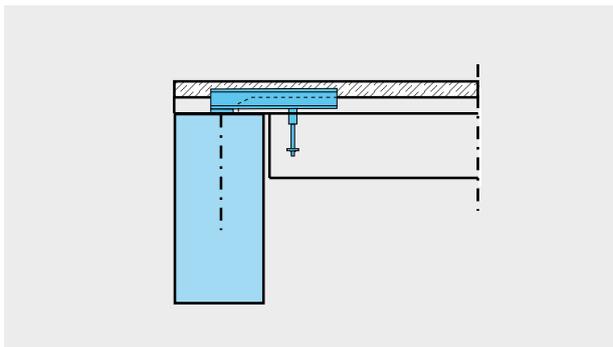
Stahlaufleger mit zentraler Auflagerung auf Randunterzug
